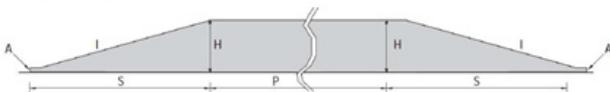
Profil général (trapézoïdal) et éléments caractéristiques d'un plateau avec rampes biseautées planes
